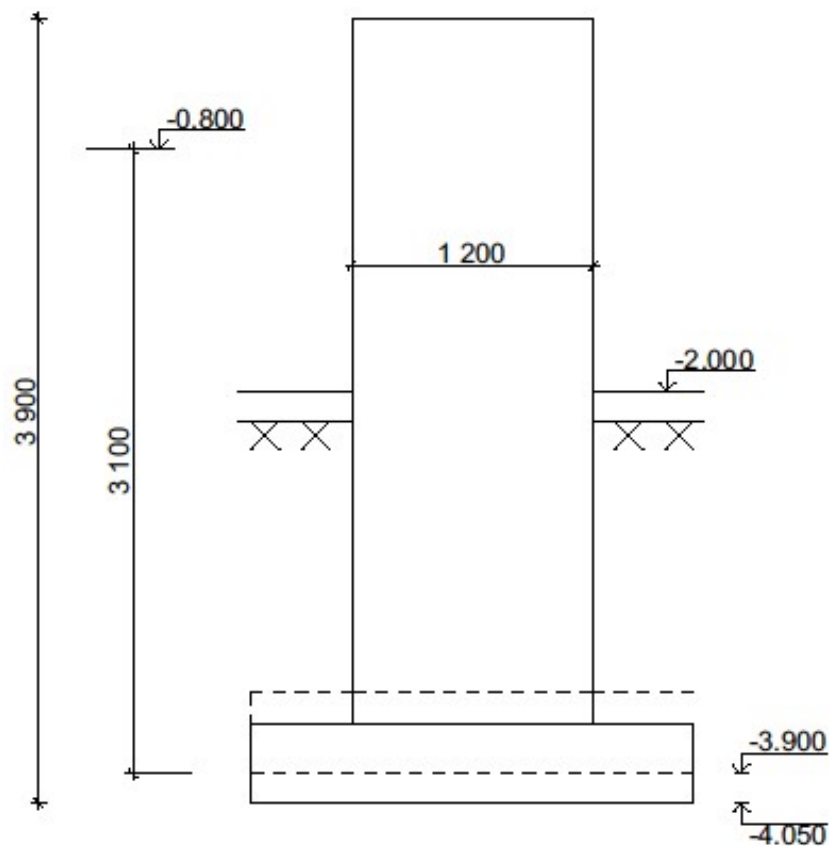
Положення фундаменту мілкового закладання у ґрунті
